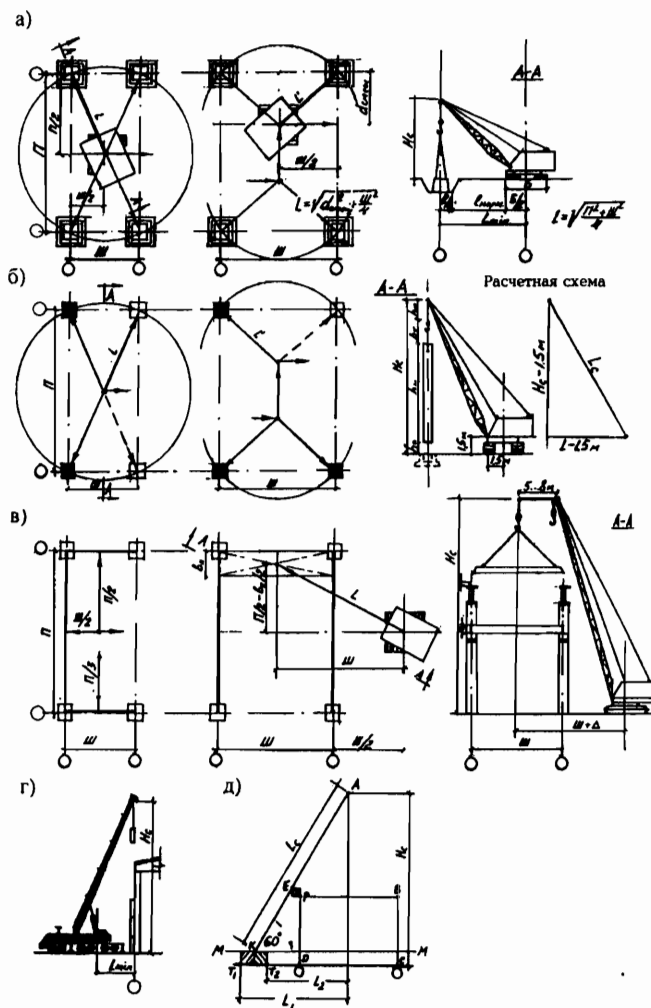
Определение основных характеристик кранов графическим методом при монтаже: а - фундаментов; б - колонн; в - ферм, подкрановых балок и плит покрытия; г - стеновых панелей; д - упрощенный способ
